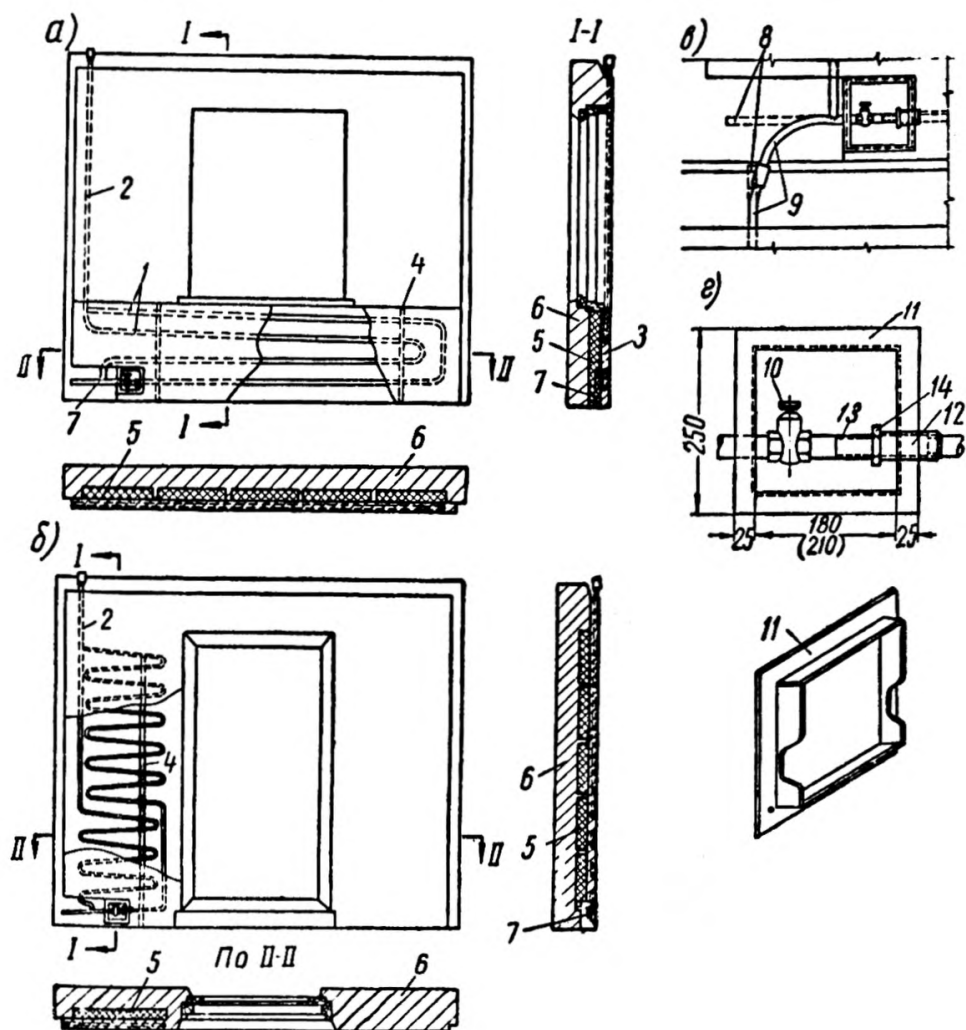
Наружные стеновые панели с нагревательными элементами панельного отопления
